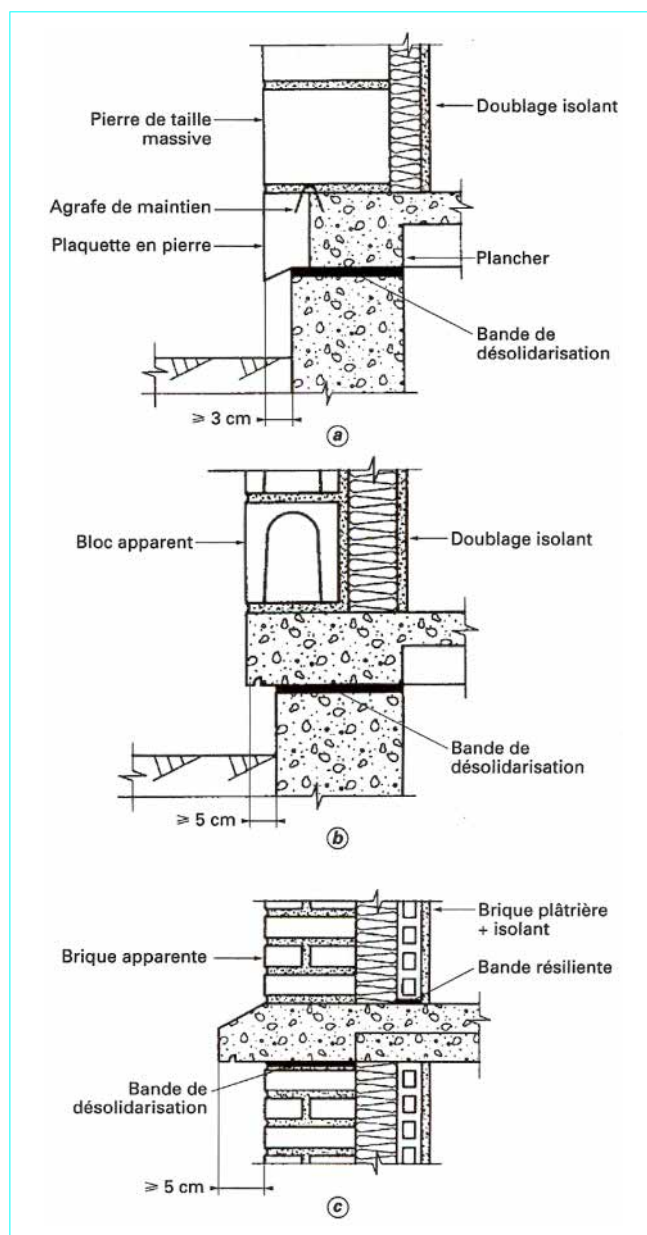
Jonction maçonnerie porteuse apparente-chaînage horizontal. Façade avec dispositif de désolidarisation
